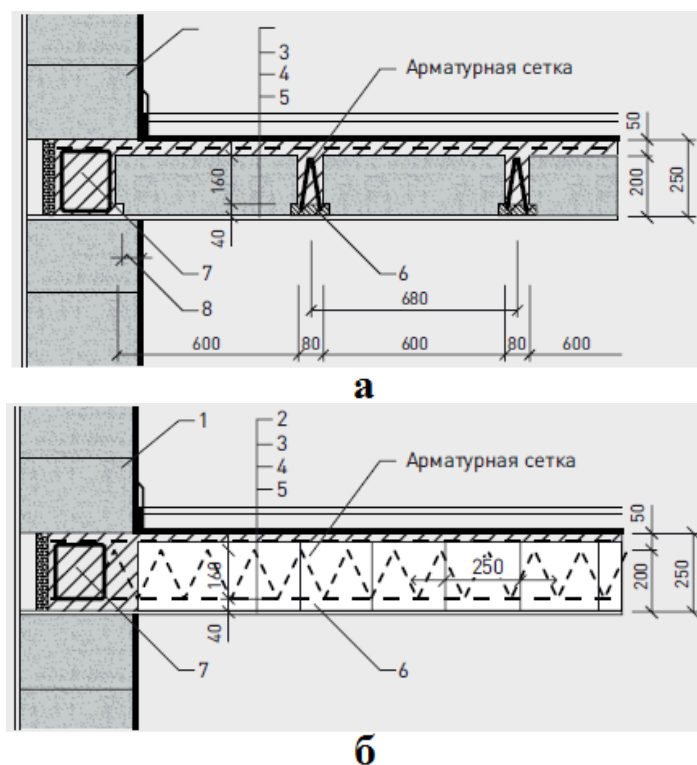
Конструкция сборно-монолитного перекрытия: а — сечение конструкции перекрытия перпендикулярно оси балки; б — сечение конструкции перекрытия параллельно оси балки; 1 — стеновой блок YTONG; 2 — конструкция пола; 3 — бетонная заливка (B20), армированная сеткой; 4 — блок перекрытия; 5 — штукатурка; 6 — балка перекрытия; 7 — монолитный пояс; 8 — зона опоры блока перекрытия (мин. 20 мм)
